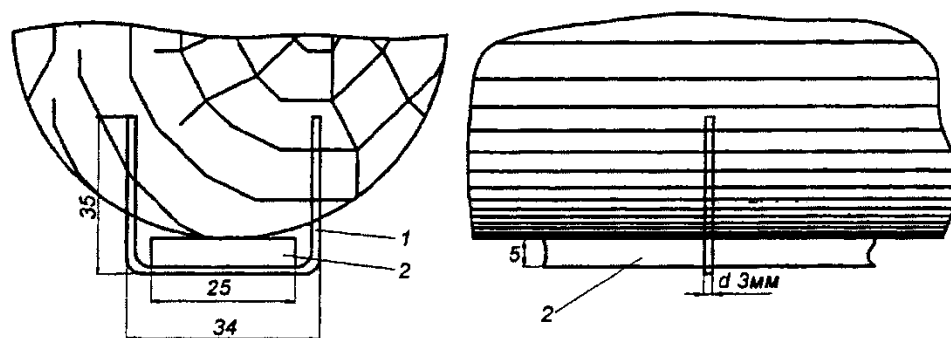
Схема крепления заземляющих проводников в выработке с деревянной крепью:
